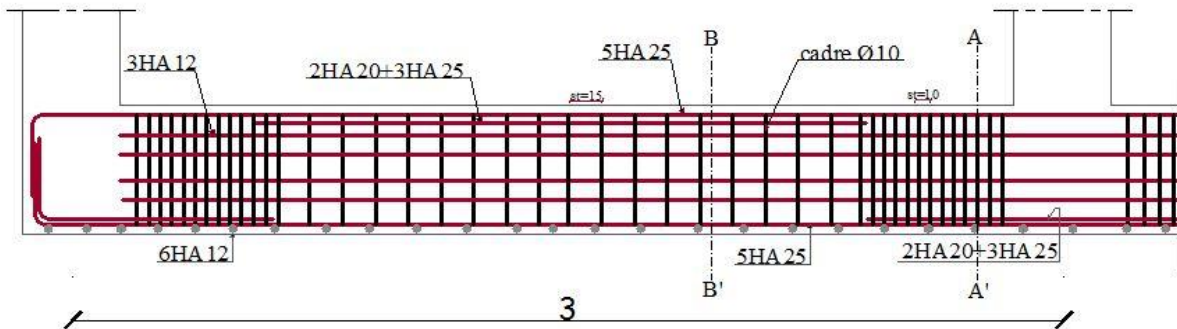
schéma de ferrailage de la semelle filante (coupe longitudinale).
